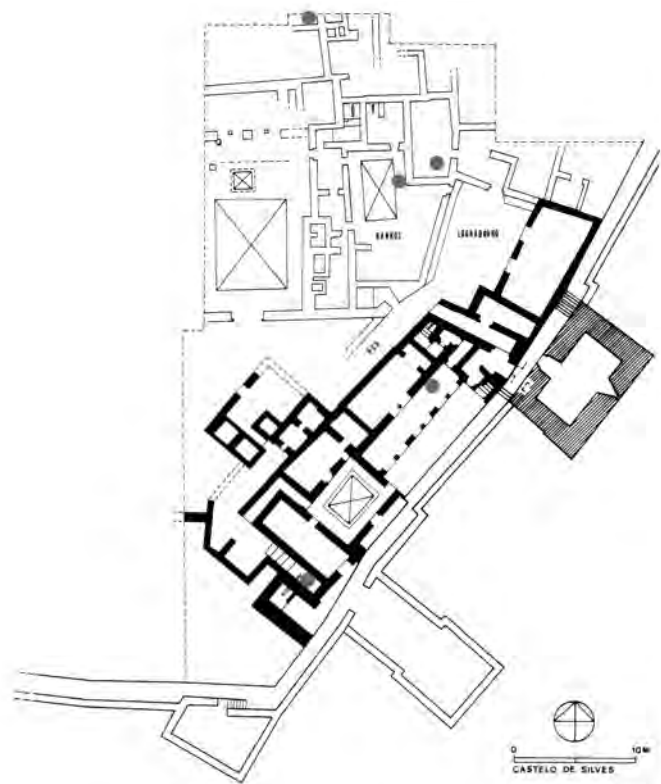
Planta das estruturas da camada 2, da zona dos palácios, do Castelo de Silves, com indicação dos locais onde se encontraram tabuleiros de jogo.
